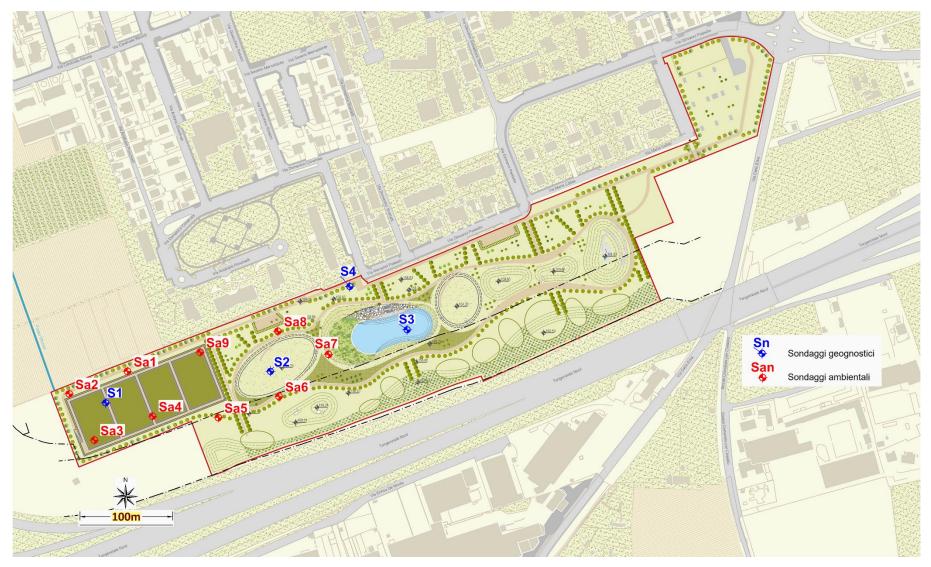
Planimetria "Parco dell'Acqua" PFTE con sovrapposte indagini di caratterizzazione ambientale
